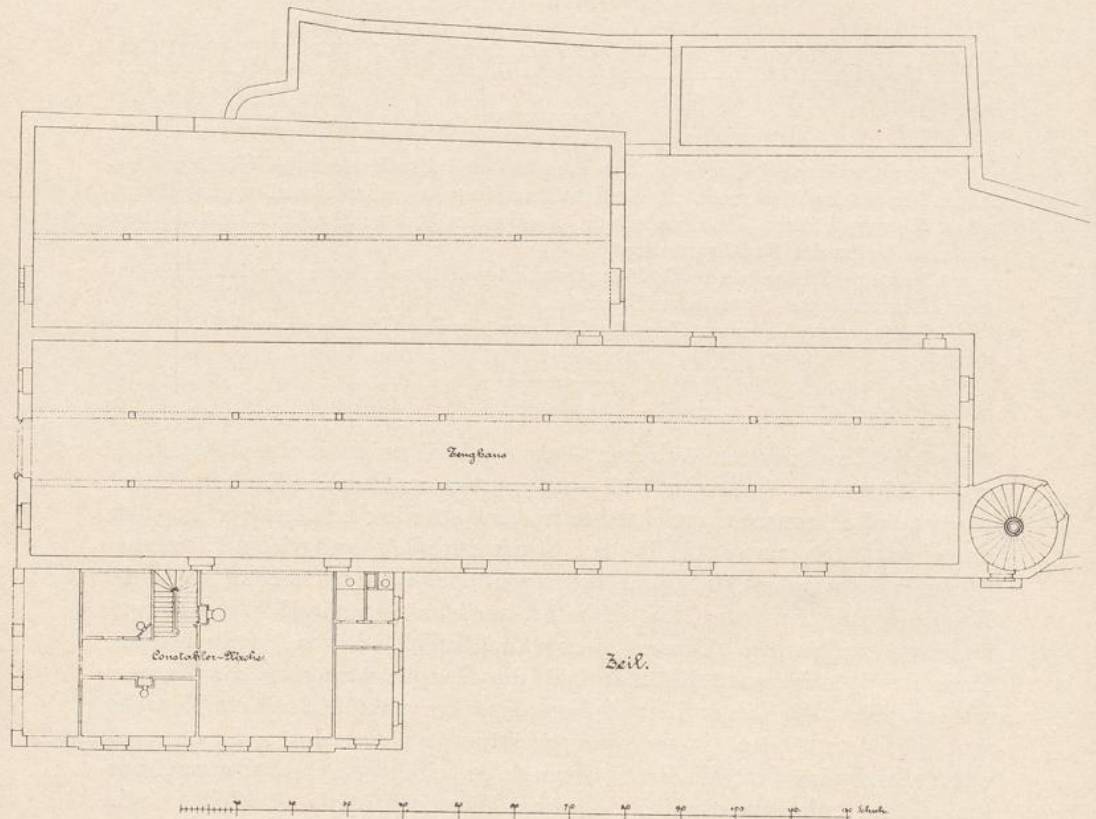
Konstabler-Wache; Grundriss.
